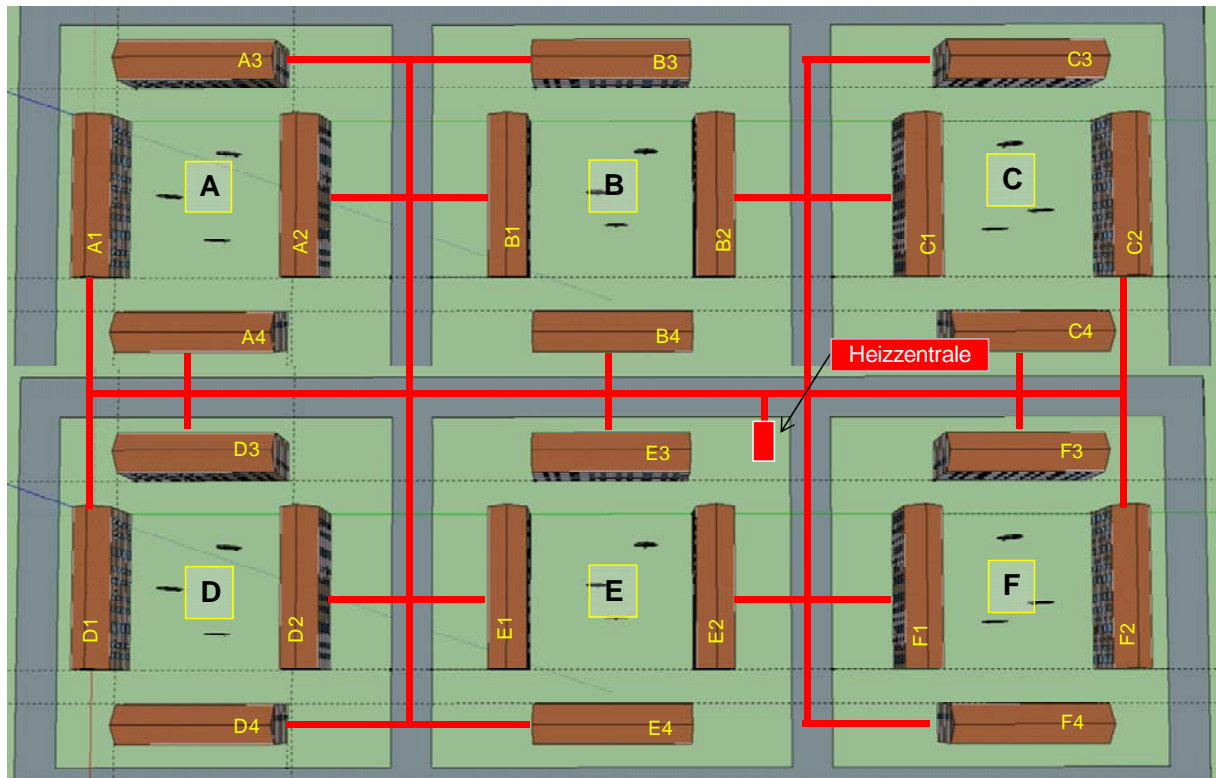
Lageplan Quartier Bestandssanierung mit Nahwärmenetz und Lage der Heizzentrale
